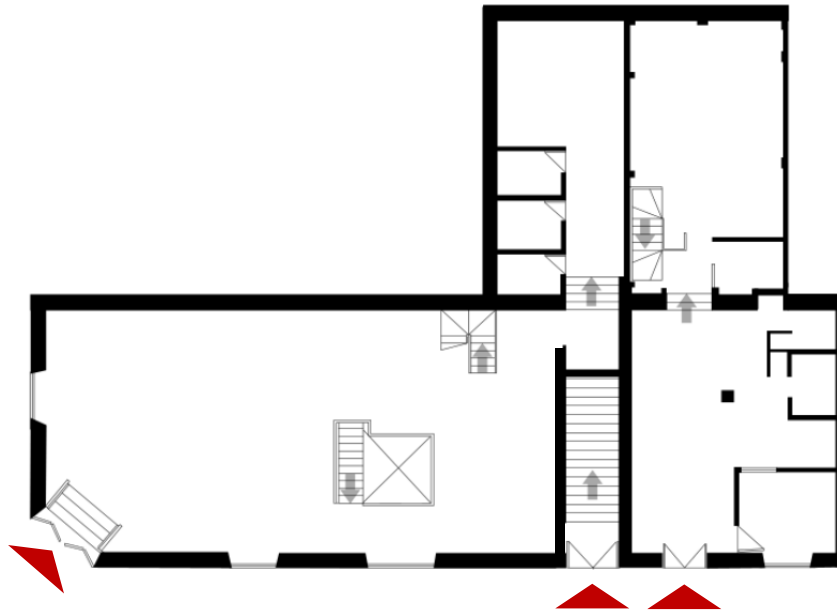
Planta arquitectónica del Primer piso: 380 m2
